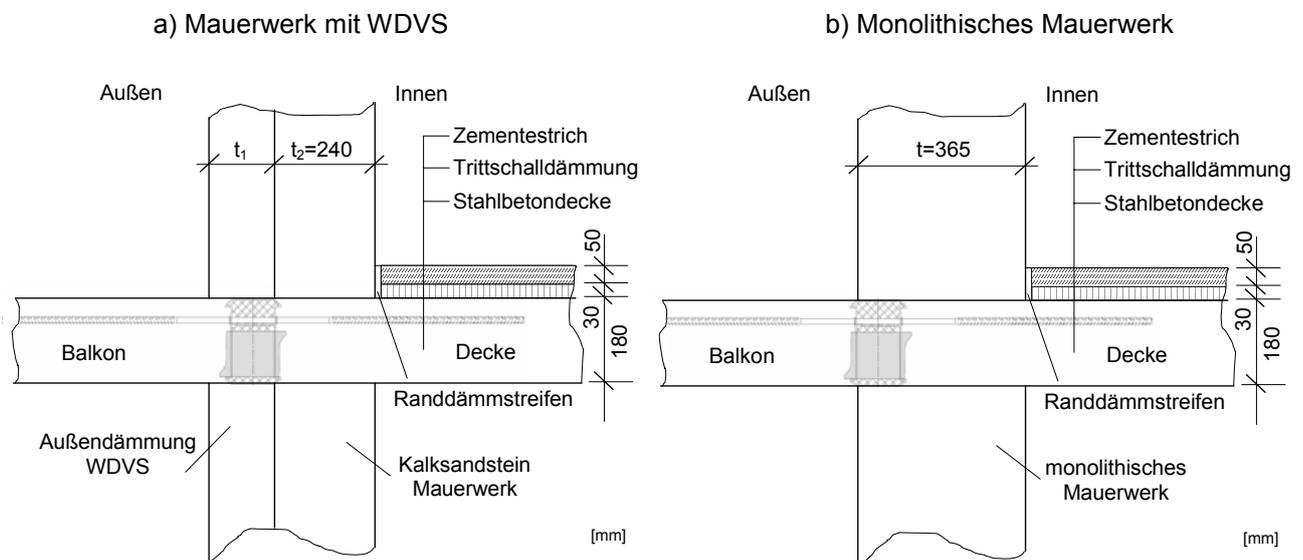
Einbausituation Mauerwerk mit WDVS und monolithisches Mauerwerk
